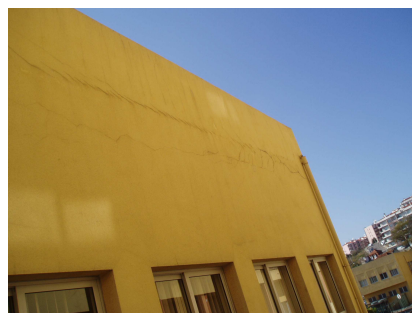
Fissuração na ligação entre a parede de alvenaria, a viga de betão e a platibanda
